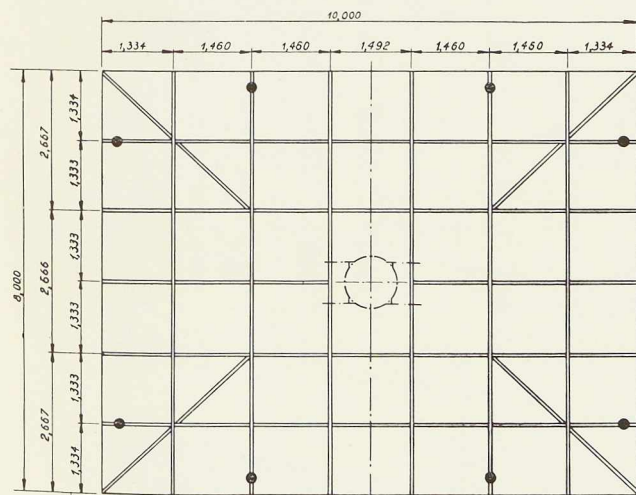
Vue en plan du caisson d'une pile du pont-route Marguerite.
